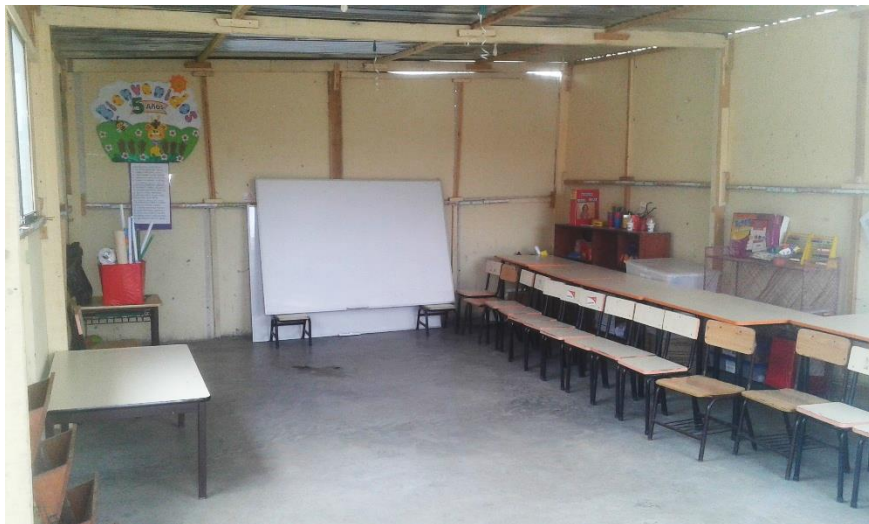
Interior de aula construida de triplay y techo de calamina metálica.
